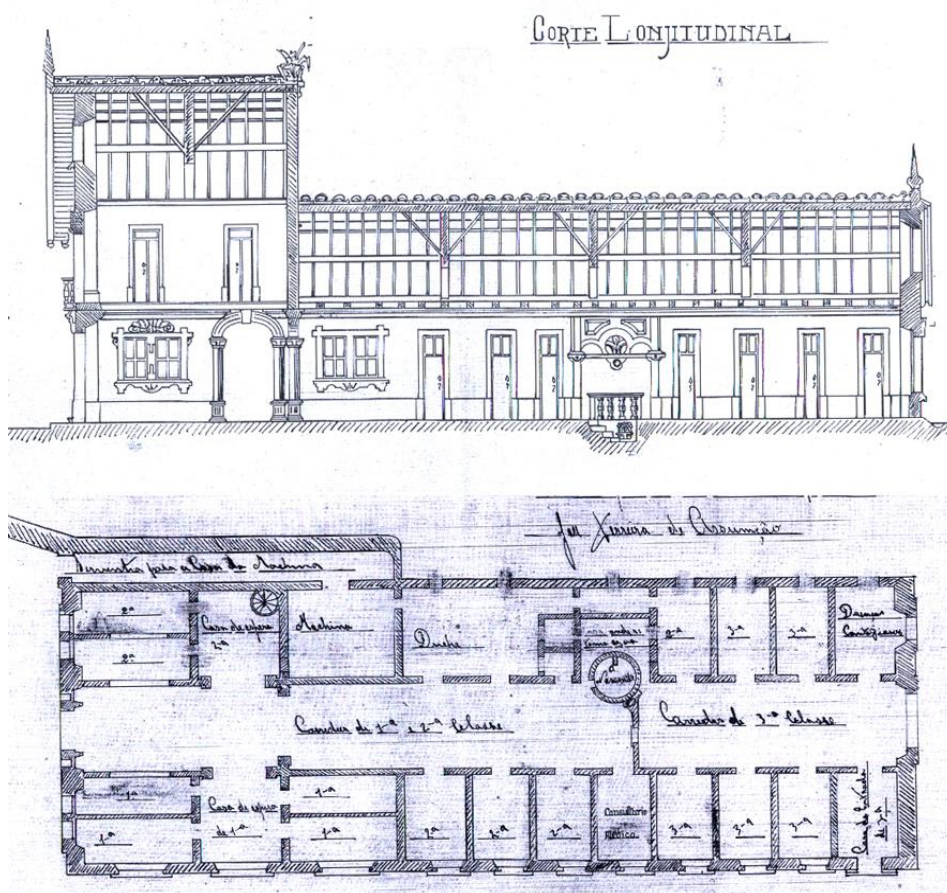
a) Corte longitudinal e b) planta piso térreo, projecto de 1915.
